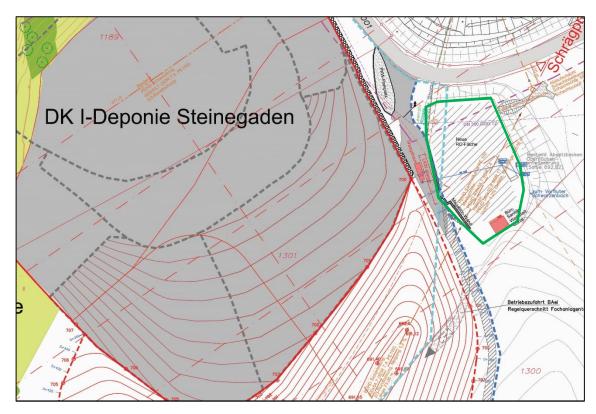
Geplanter Standort der Bauschuttaufbereitung inkl. Lagerflächen (grün)
